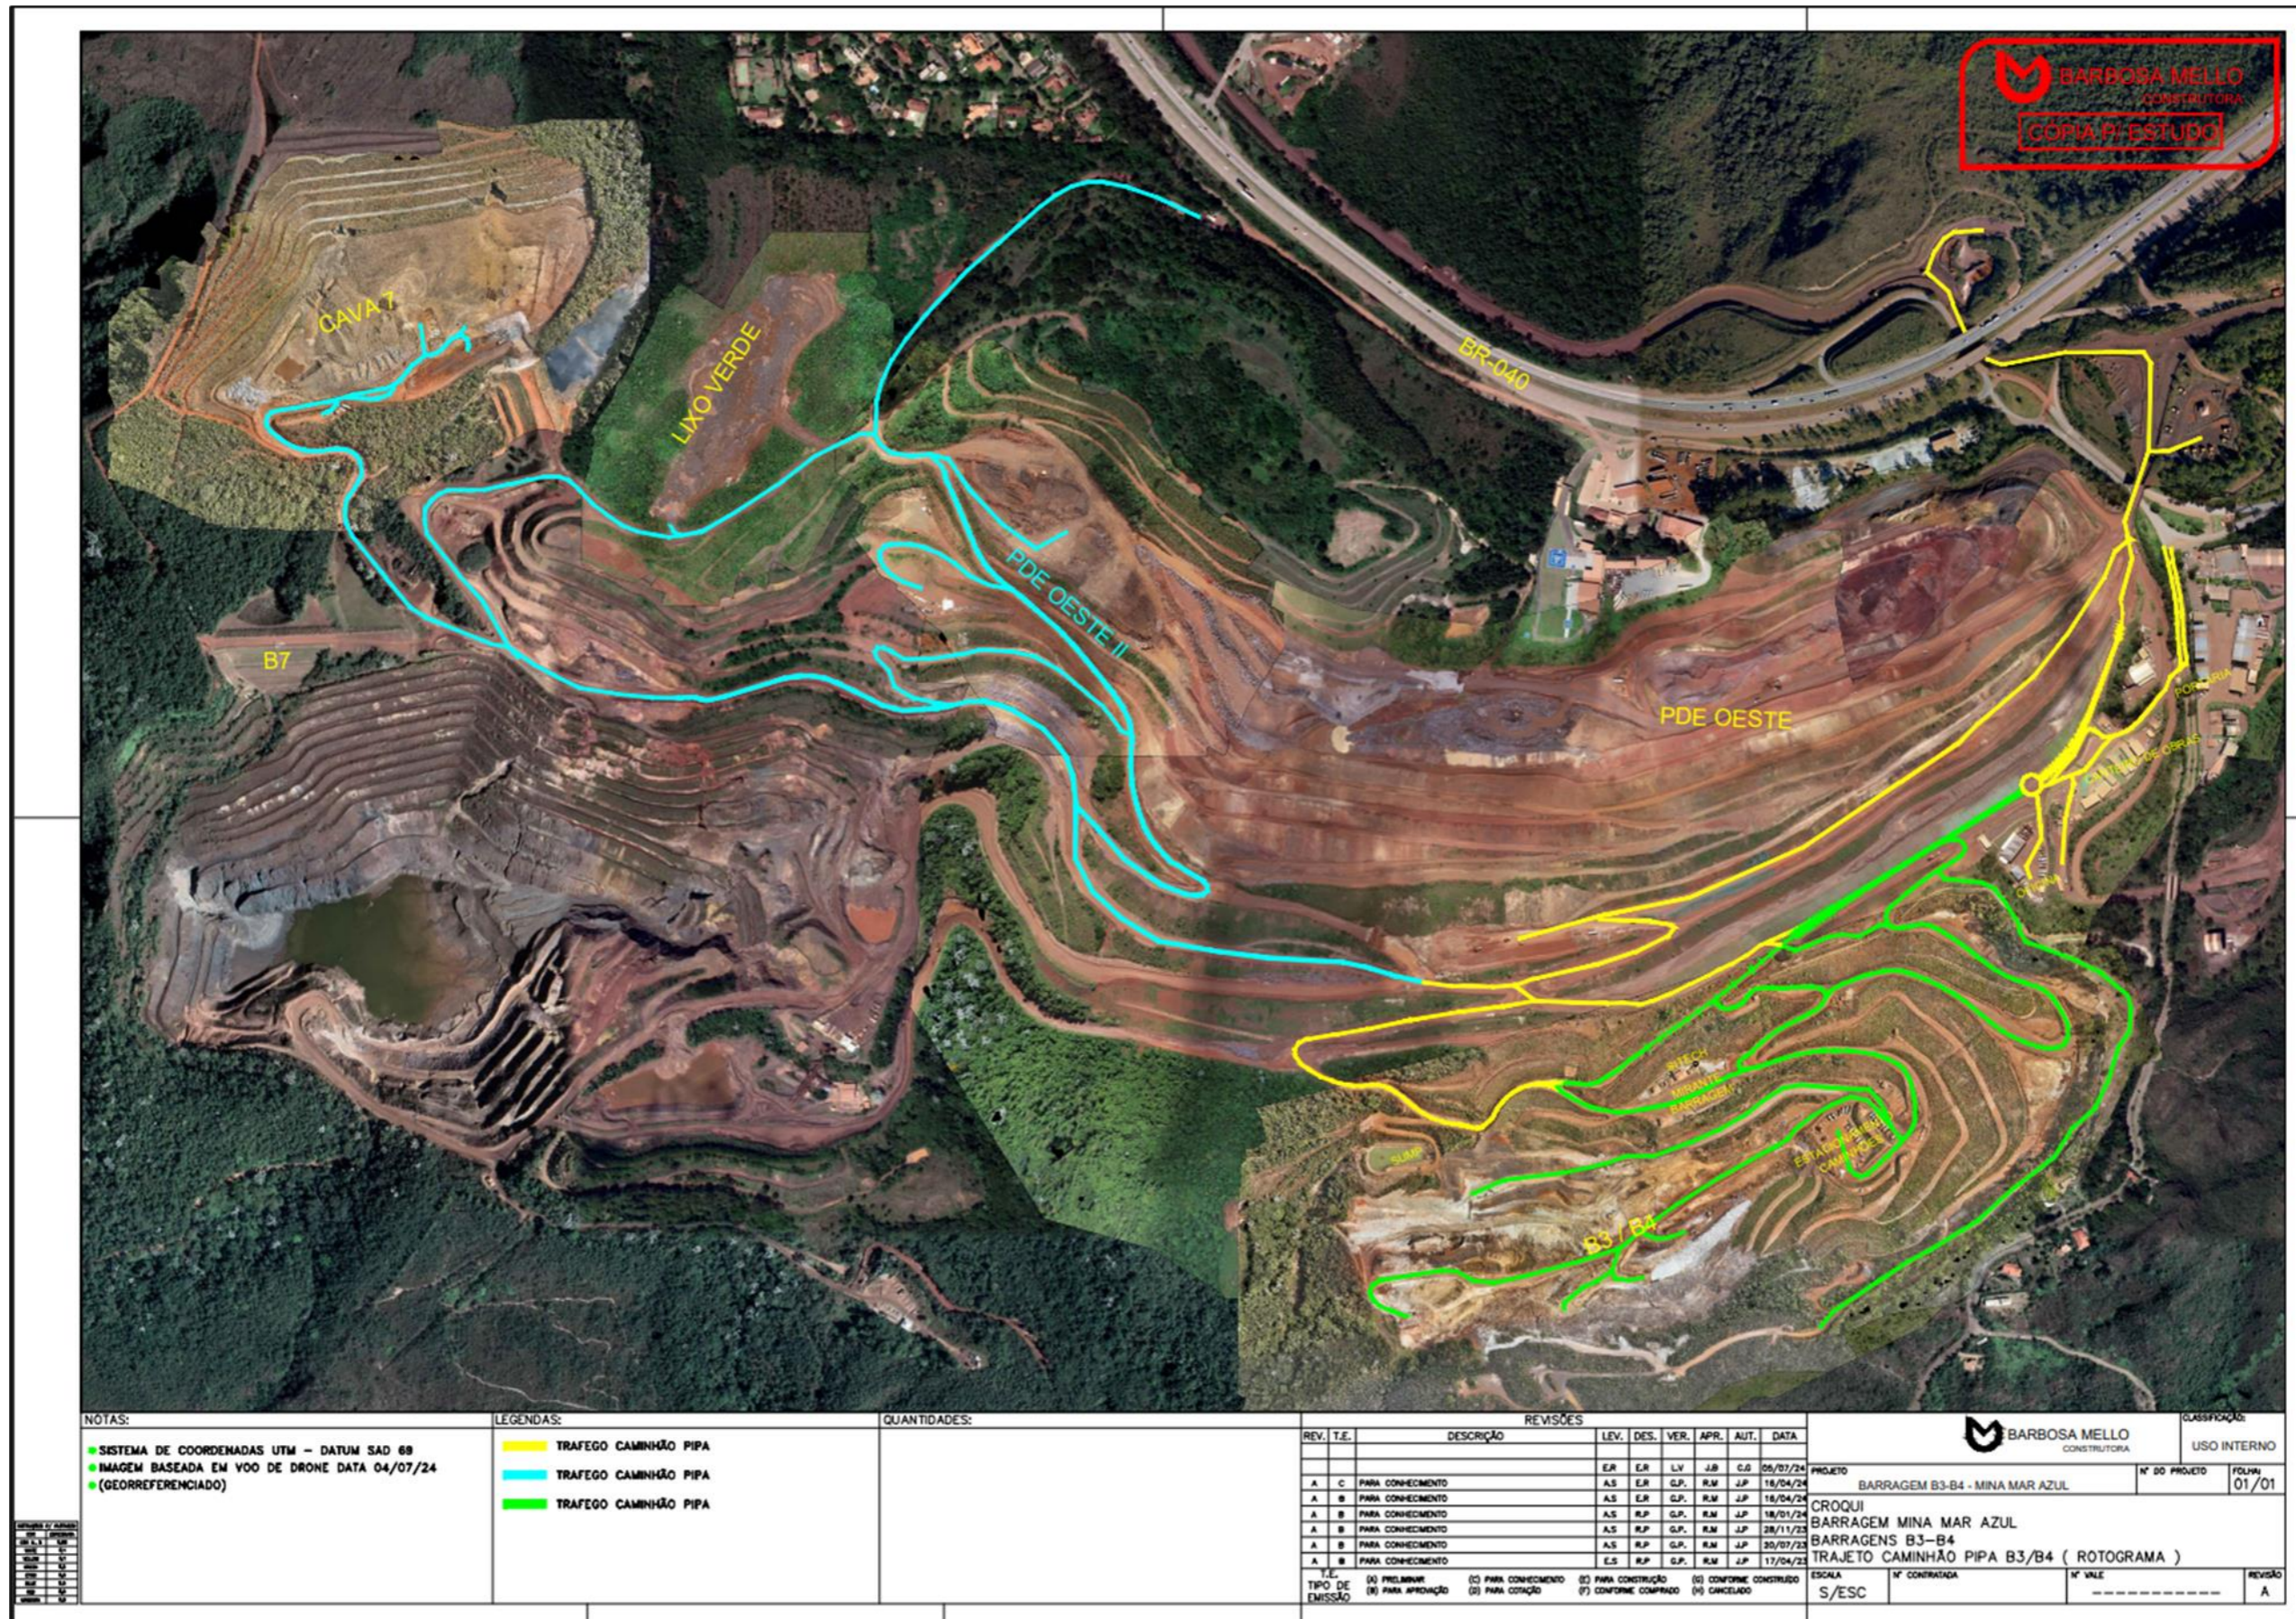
Umectação nos acessos ao canteiro. (Fonte: Vale, 03 de julho de 2024).
